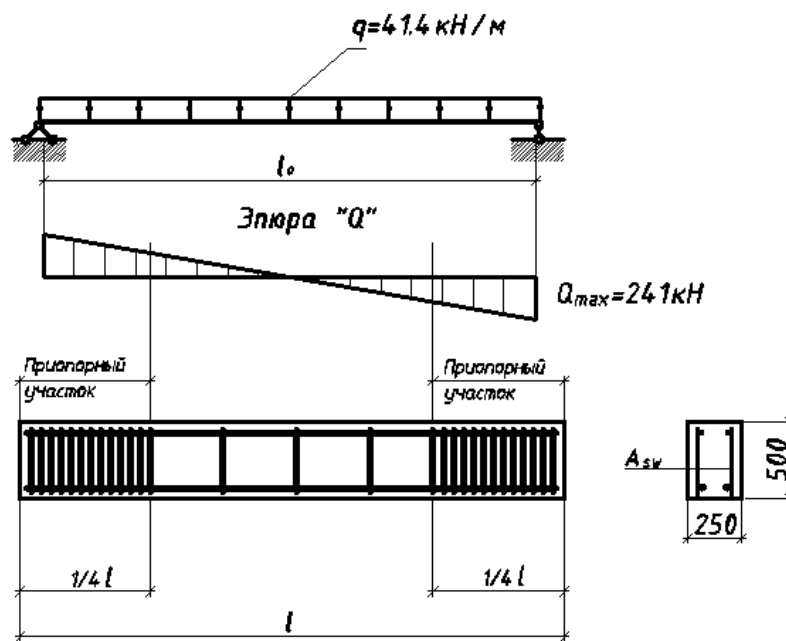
Расчетная схема балки, эпюра  $Q$  и схема армирования
